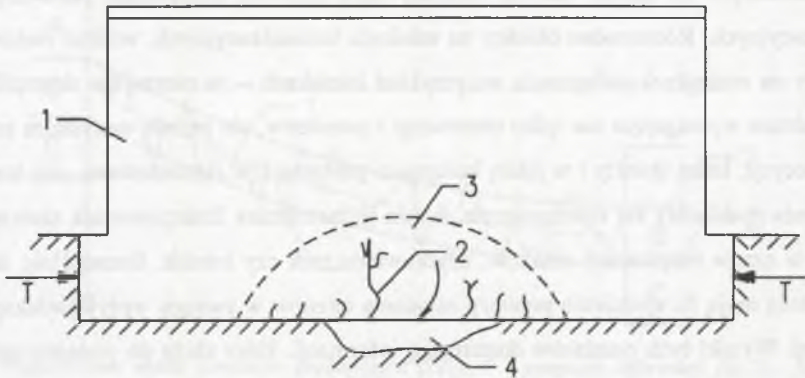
Spękania konstrukcji w strefie rozciągania: 1 – bryła konstrukcyjna, 2 – zdeformowane podłożo, 3 – spękania
